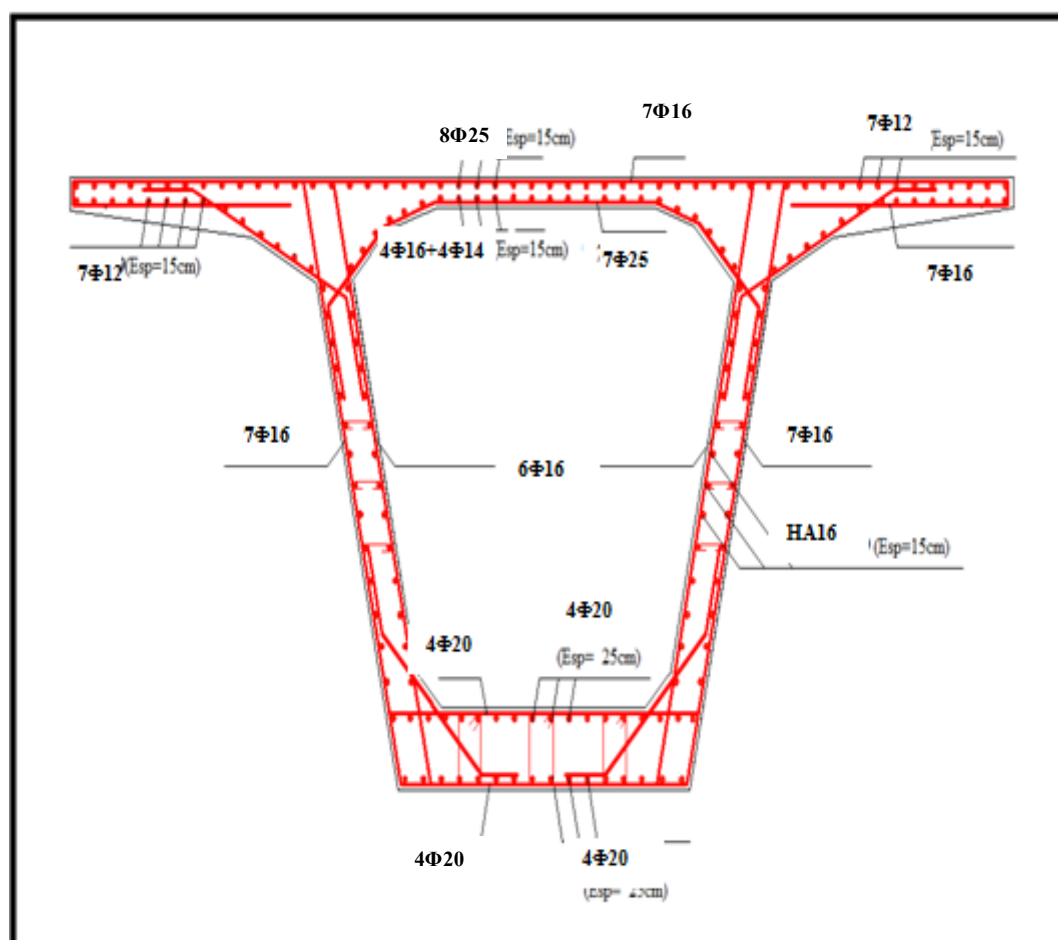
Schéma du Ferrailage du voussoir près de la pile.
